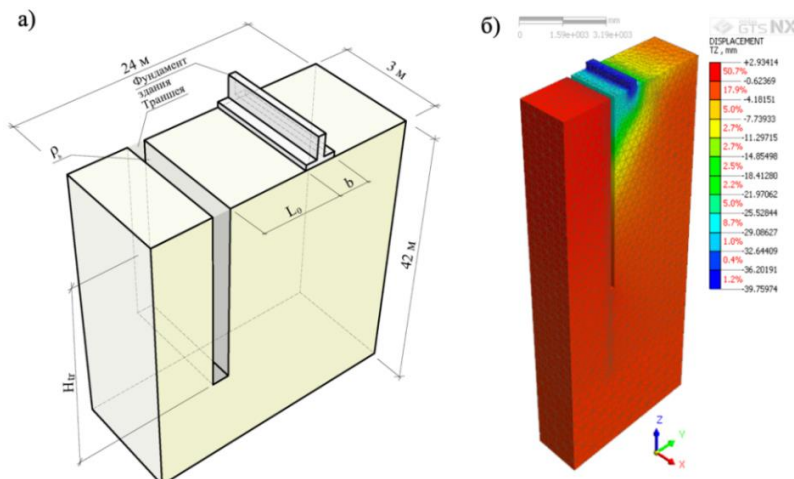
К расчету осадок фундаментов, вызванных разработкой траншеи по схеме 3:
